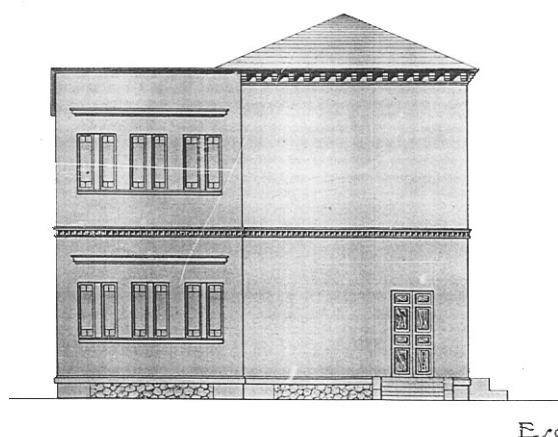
Alzado del CEIP Macías Picavea. Ayuntamiento de Valladolid.
